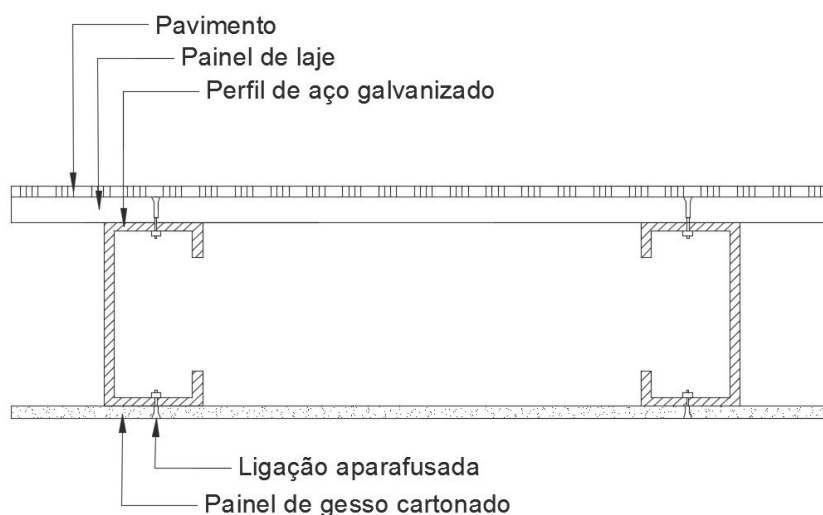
Pormenor construtivo de laje de piso em sistema LGSF com recurso a painel de laje
